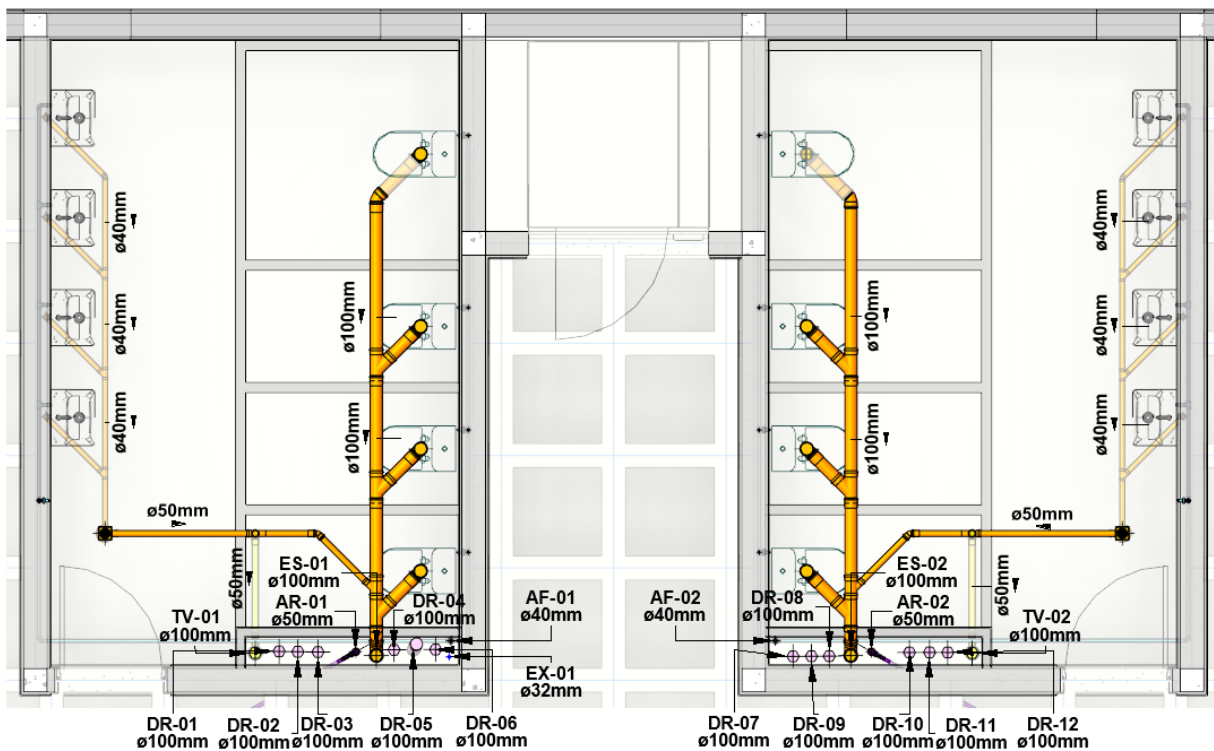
Visualização Geral do Projeto Hidrossanitário
